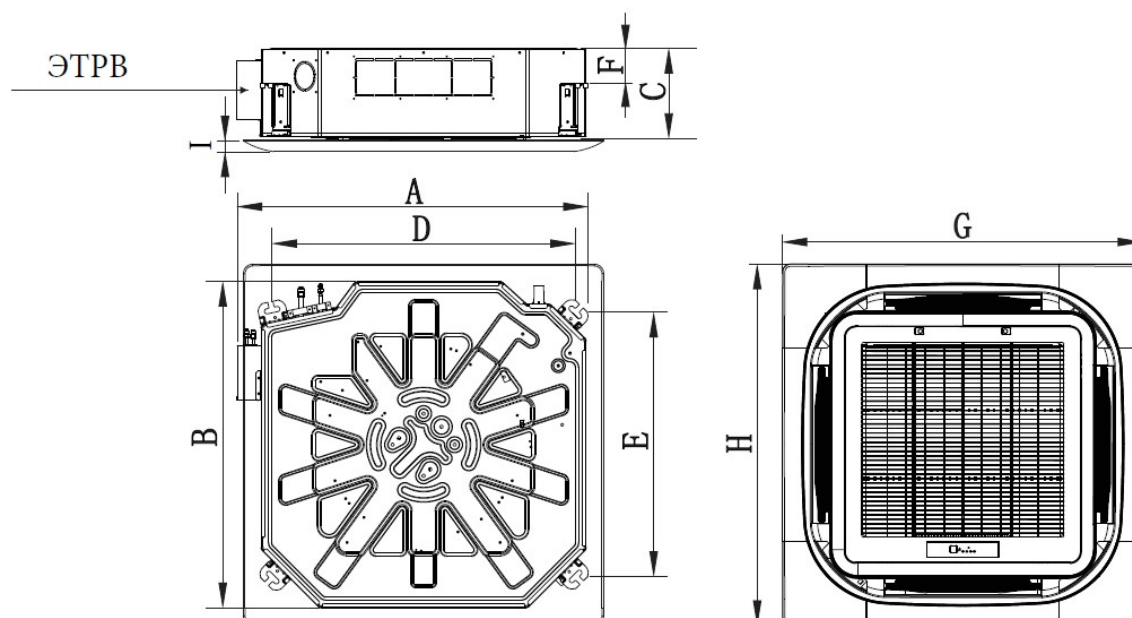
Внешний вид и размер воздуховыпускного отверстия кассетного блока (3)
